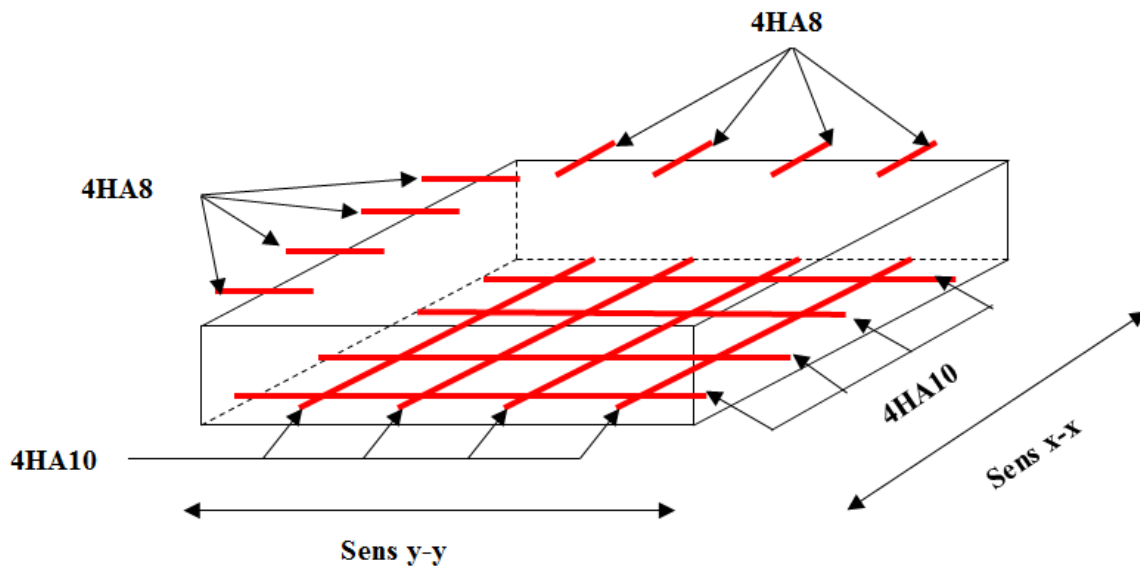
Schéma de ferrailage de la dalle pleine du local machinerie
